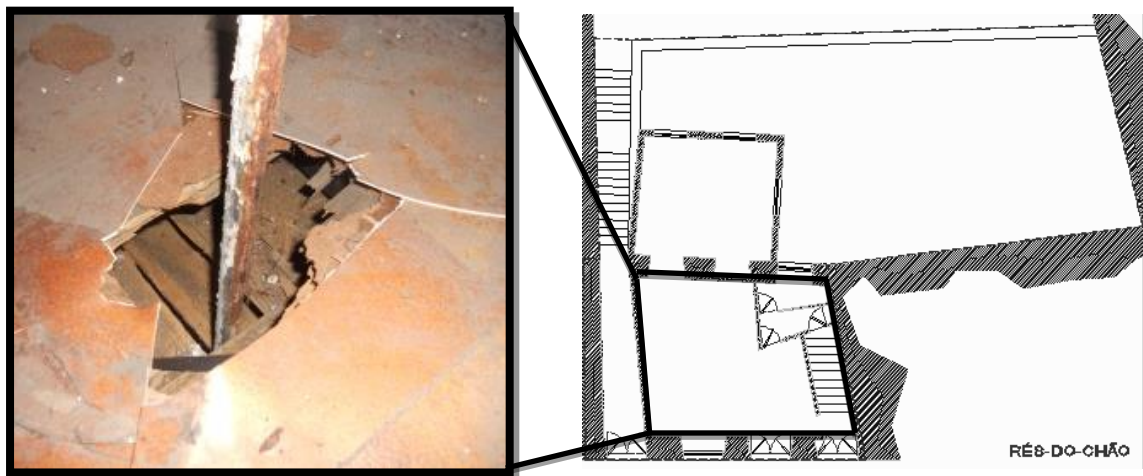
Anomalia 6 - Fotografia e localização em planta
